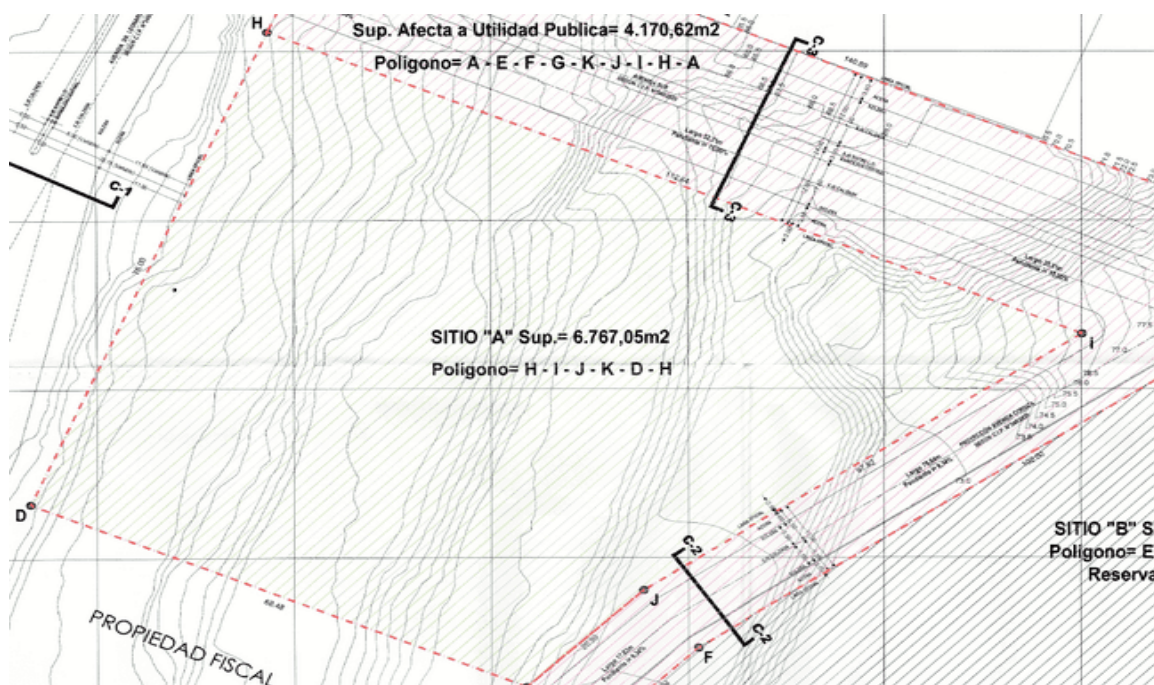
Emplazamiento según plano de subdivisión predial afecta, sitio A.
